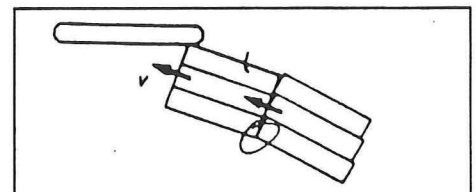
Pijler Noord, overzicht van de constructie (caisson)
